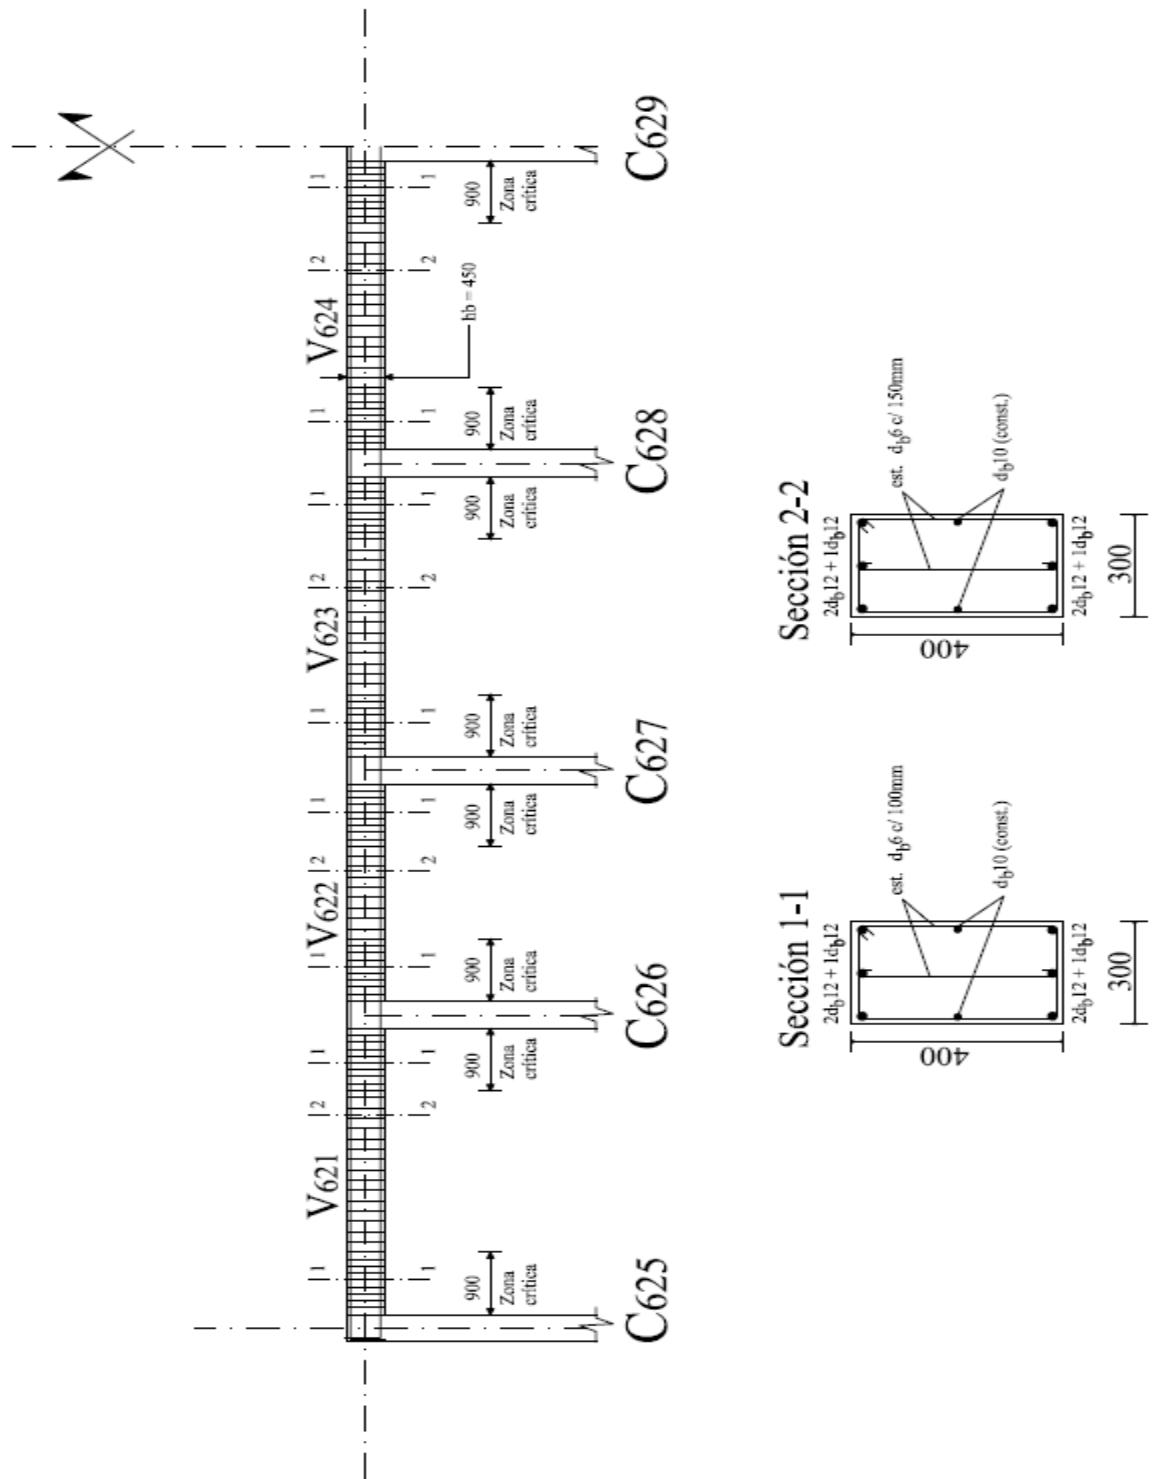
DETALLE DE ARMADO DE VIGAS (Vigas Nivel 6 – Pórtico X5); (mm)
